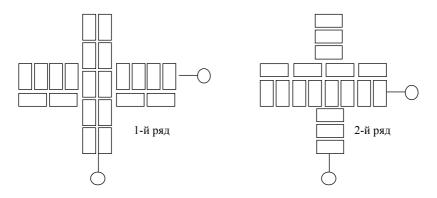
Кладка пересечений стен толщиной в 1,5 и 1 кирпич
